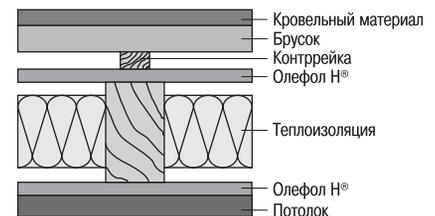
Конструкция крыши с двумя воздушными зазорами
